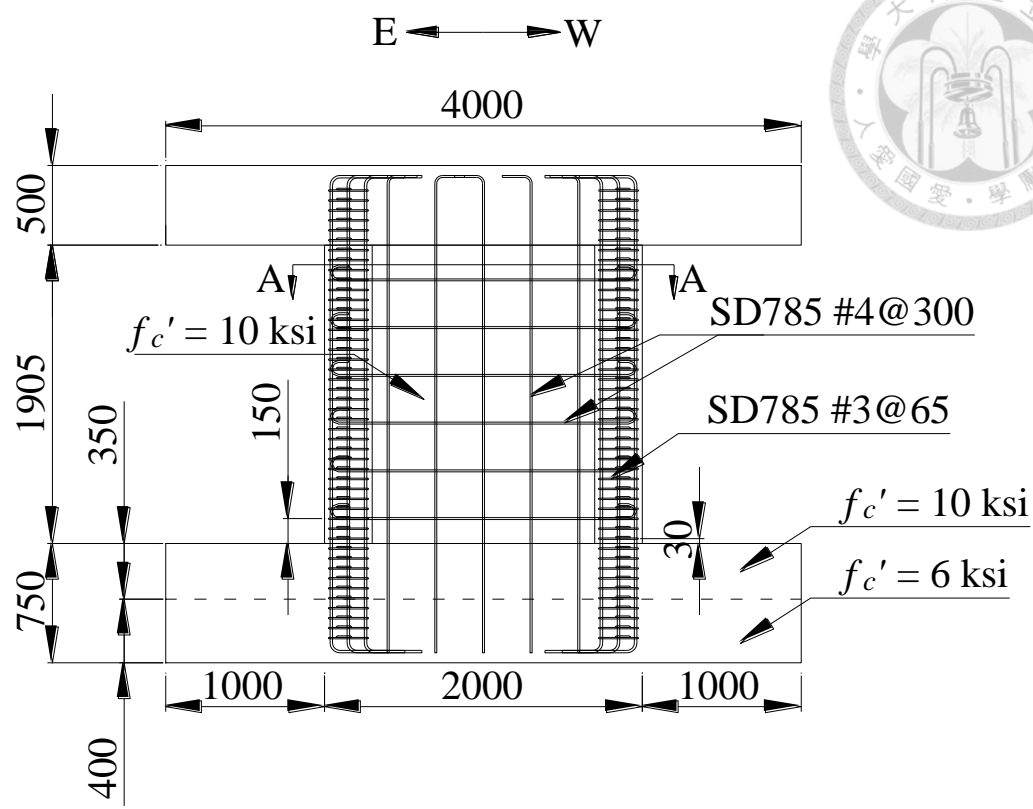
試體 WB 配筋圖 (Unit: mm)
